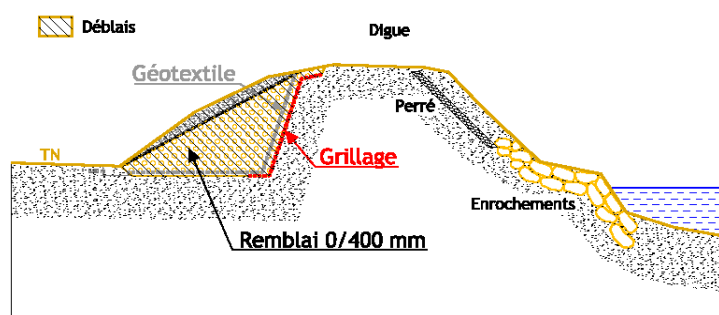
Coupe type d'un chantier de traitement de terriers de blaireaux. Chantier Digue Isère aval à Noyarey (38) (Crédit Photo : SYMBHI)
